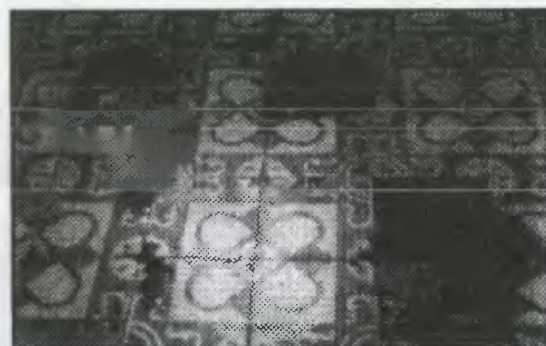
El piso instalado en 1918-20 se encuentra deteriorado y con elementos faltantes.
